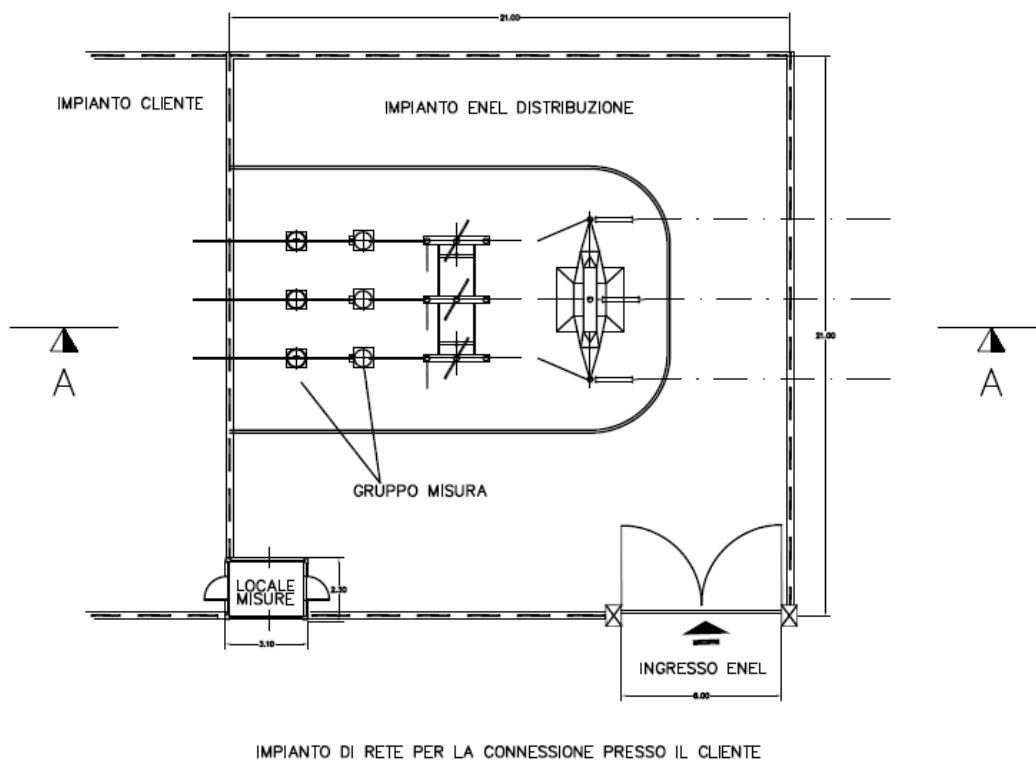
Allacciamento Cliente AT Passivo in antenna da Cabina Primaria con linea AT di proprietà di Enel (Vista in pianta di impianto di rete per la connessione presso il Cliente).
